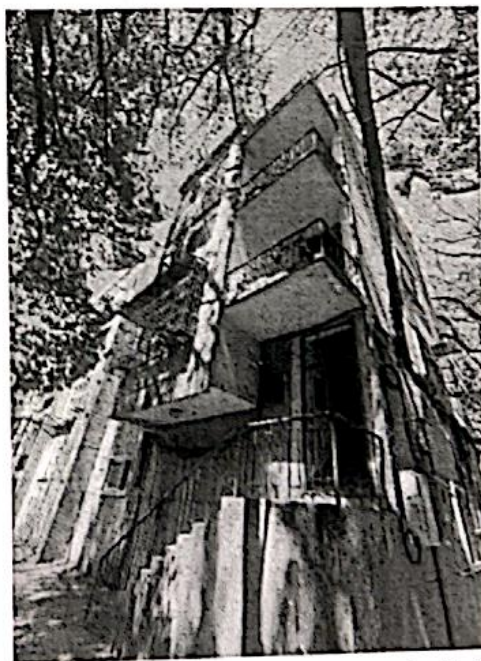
悬挑构件混凝土破损、钢筋锈蚀 1
